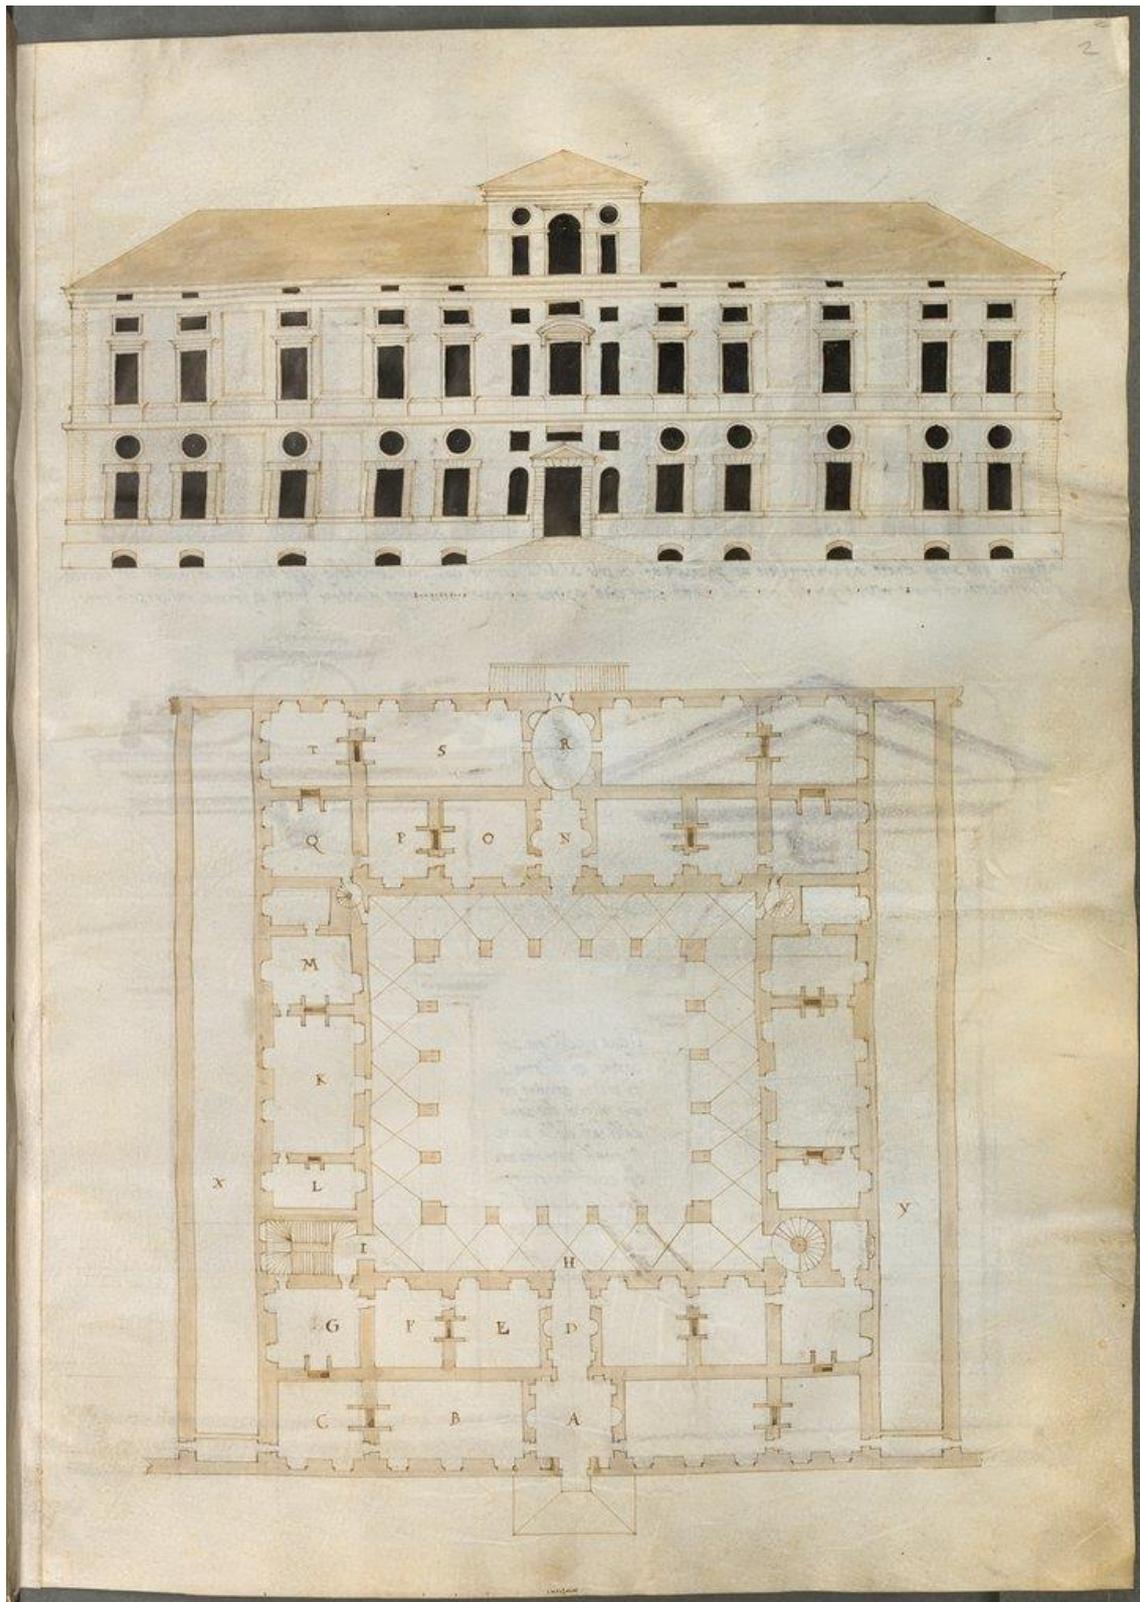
Sebastián Serlio. *Octavo libro de arquitectura*. Alzado y planta de un edificio.
